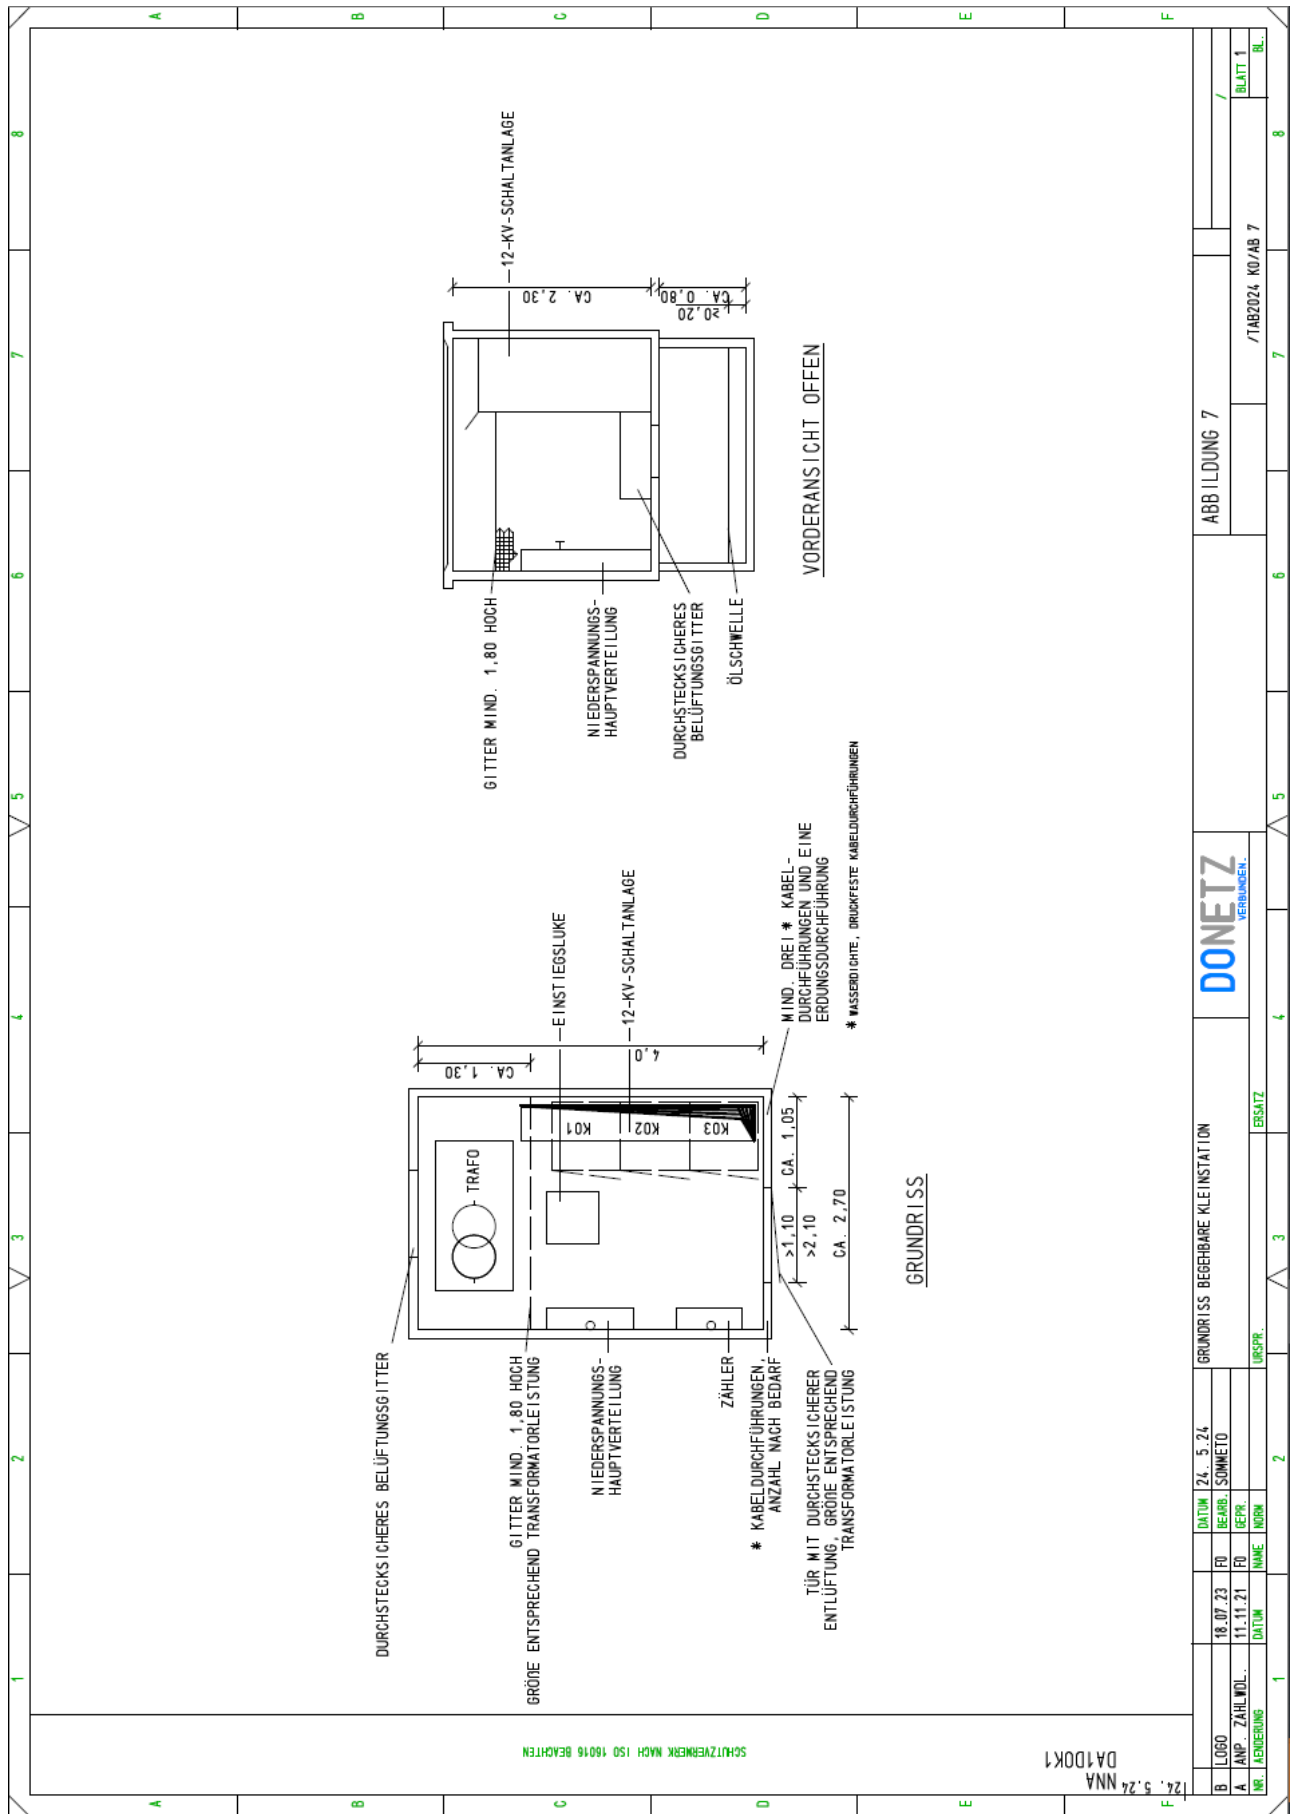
Mustergrundriss einer begehbaren Station mit einem Transformator
